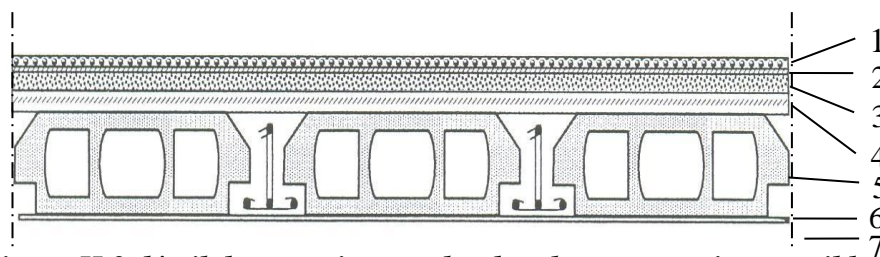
détail des constituants du plancher terrasse inaccessible.
